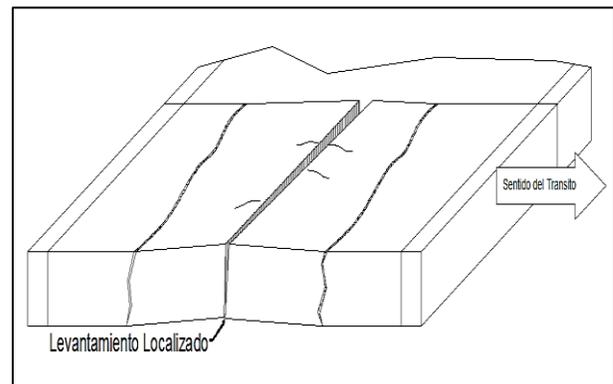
Esquema falla por levantamiento localizado (Autor, 2013).
